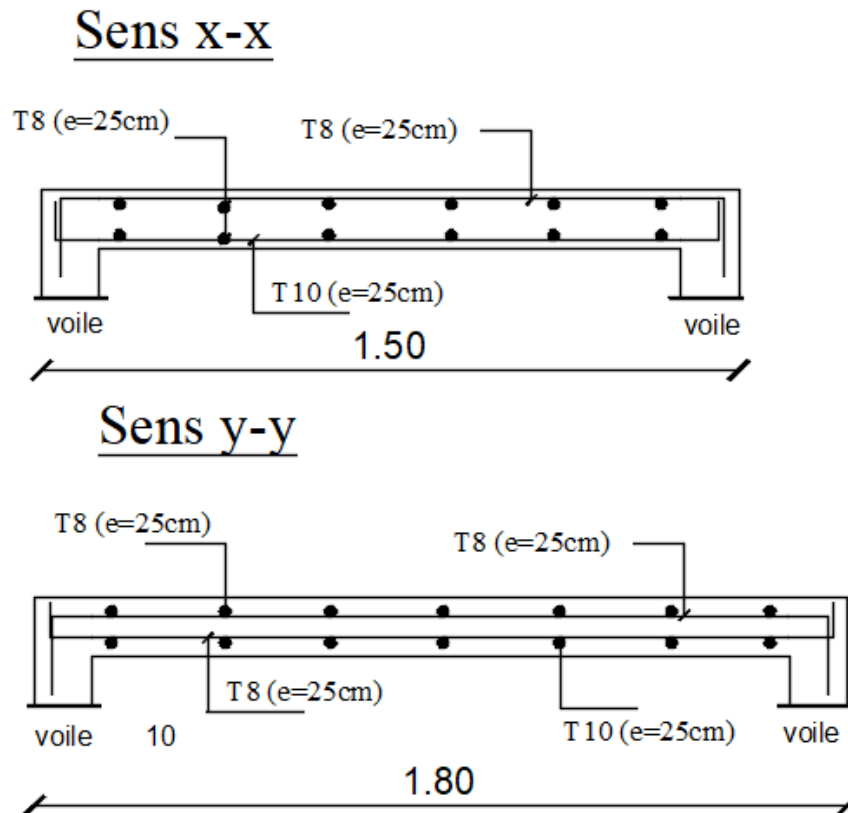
Schéma de ferrailage de la dalle salle machine
